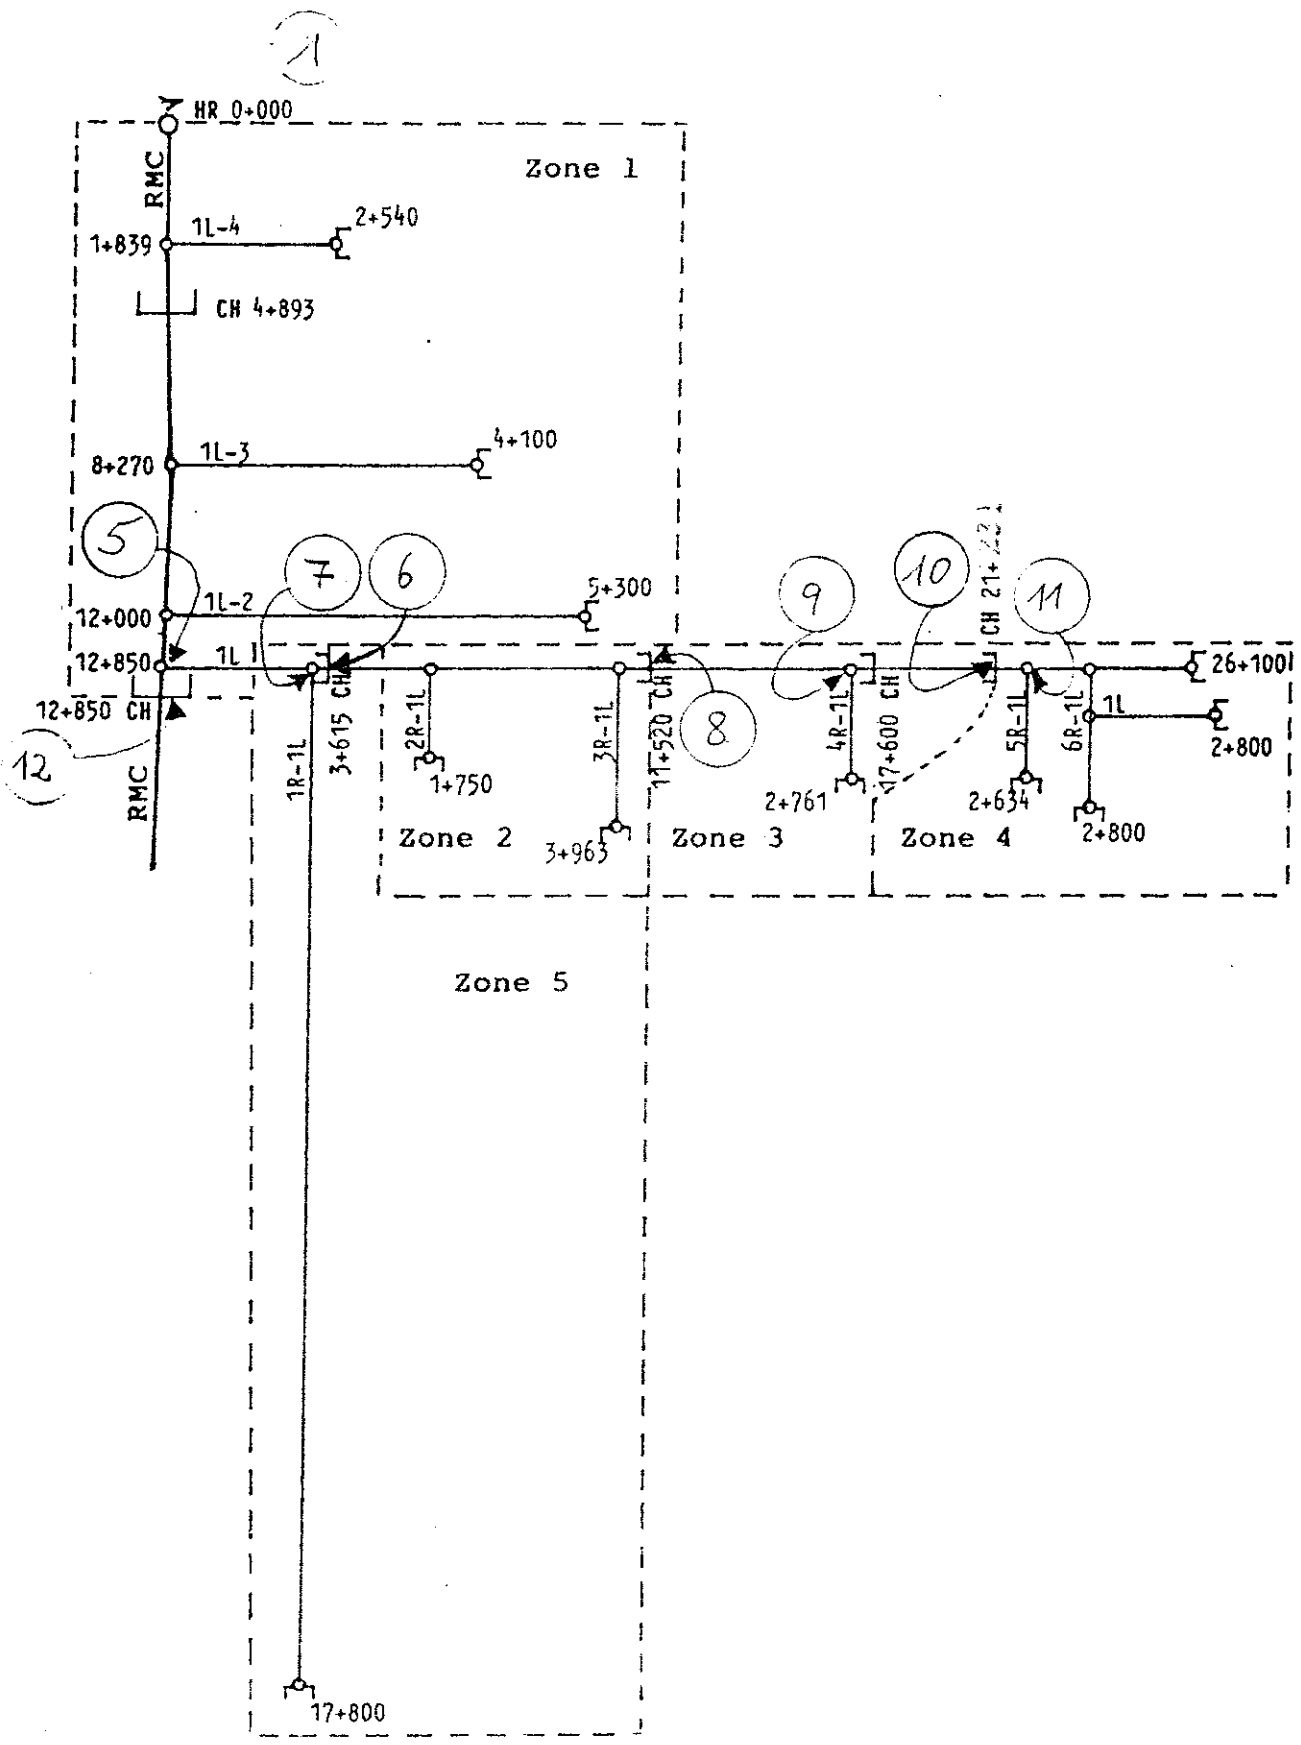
Schematic layout ของโครงการชลประทานลำปาว
